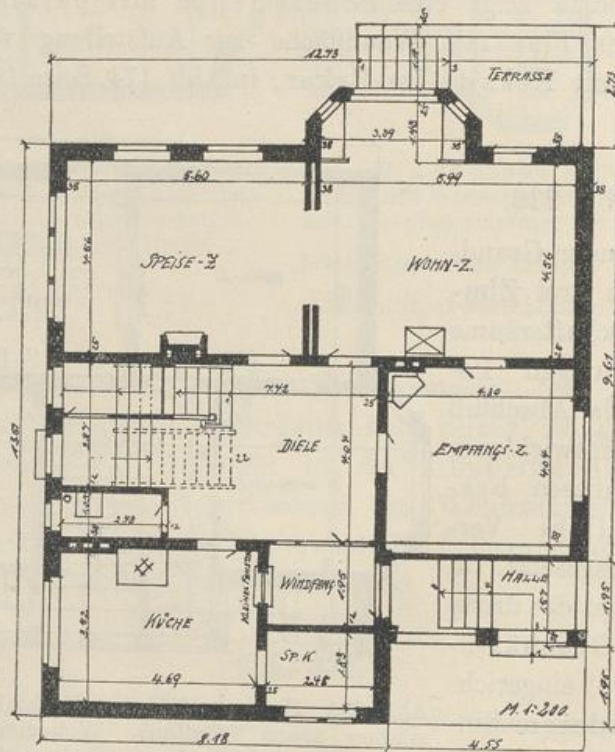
Landhaus mit Diele. Küche neben Windfang. Wohnzimmer mit Erker und Ausgang nach Terrasse mit Treppe nach dem Garten.
